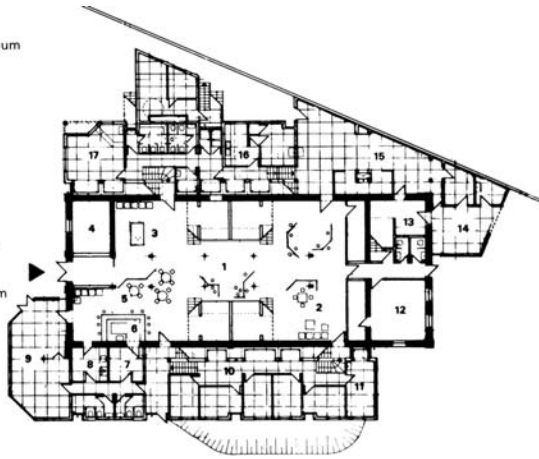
Jugendzentrum Hoechst, Frankfurt-Hoechst, Grundriß Erdgeschoß
